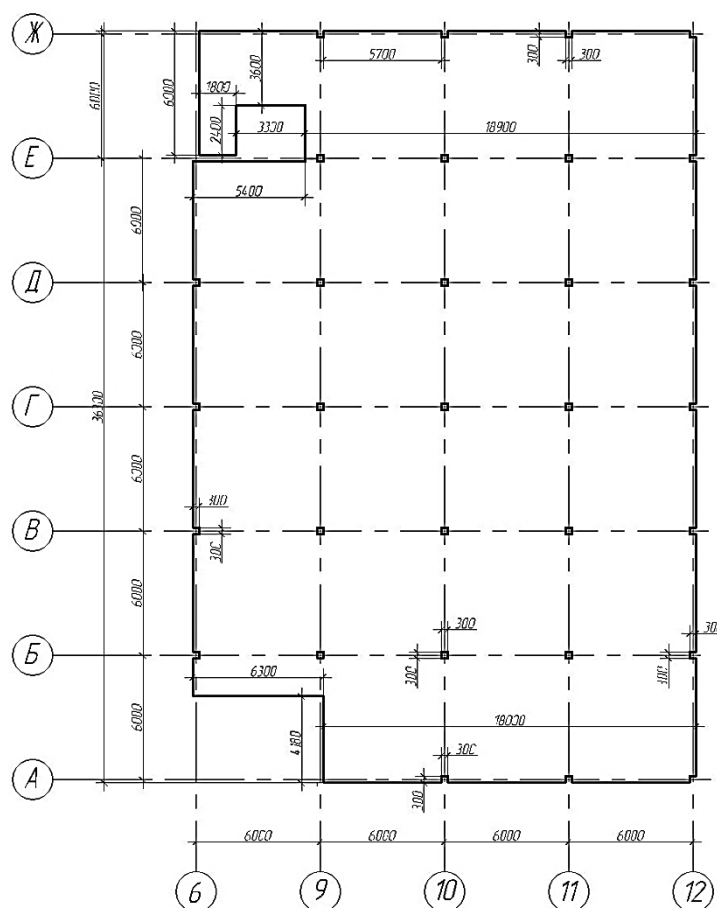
Геометрическая схема монолитного перекрытия
